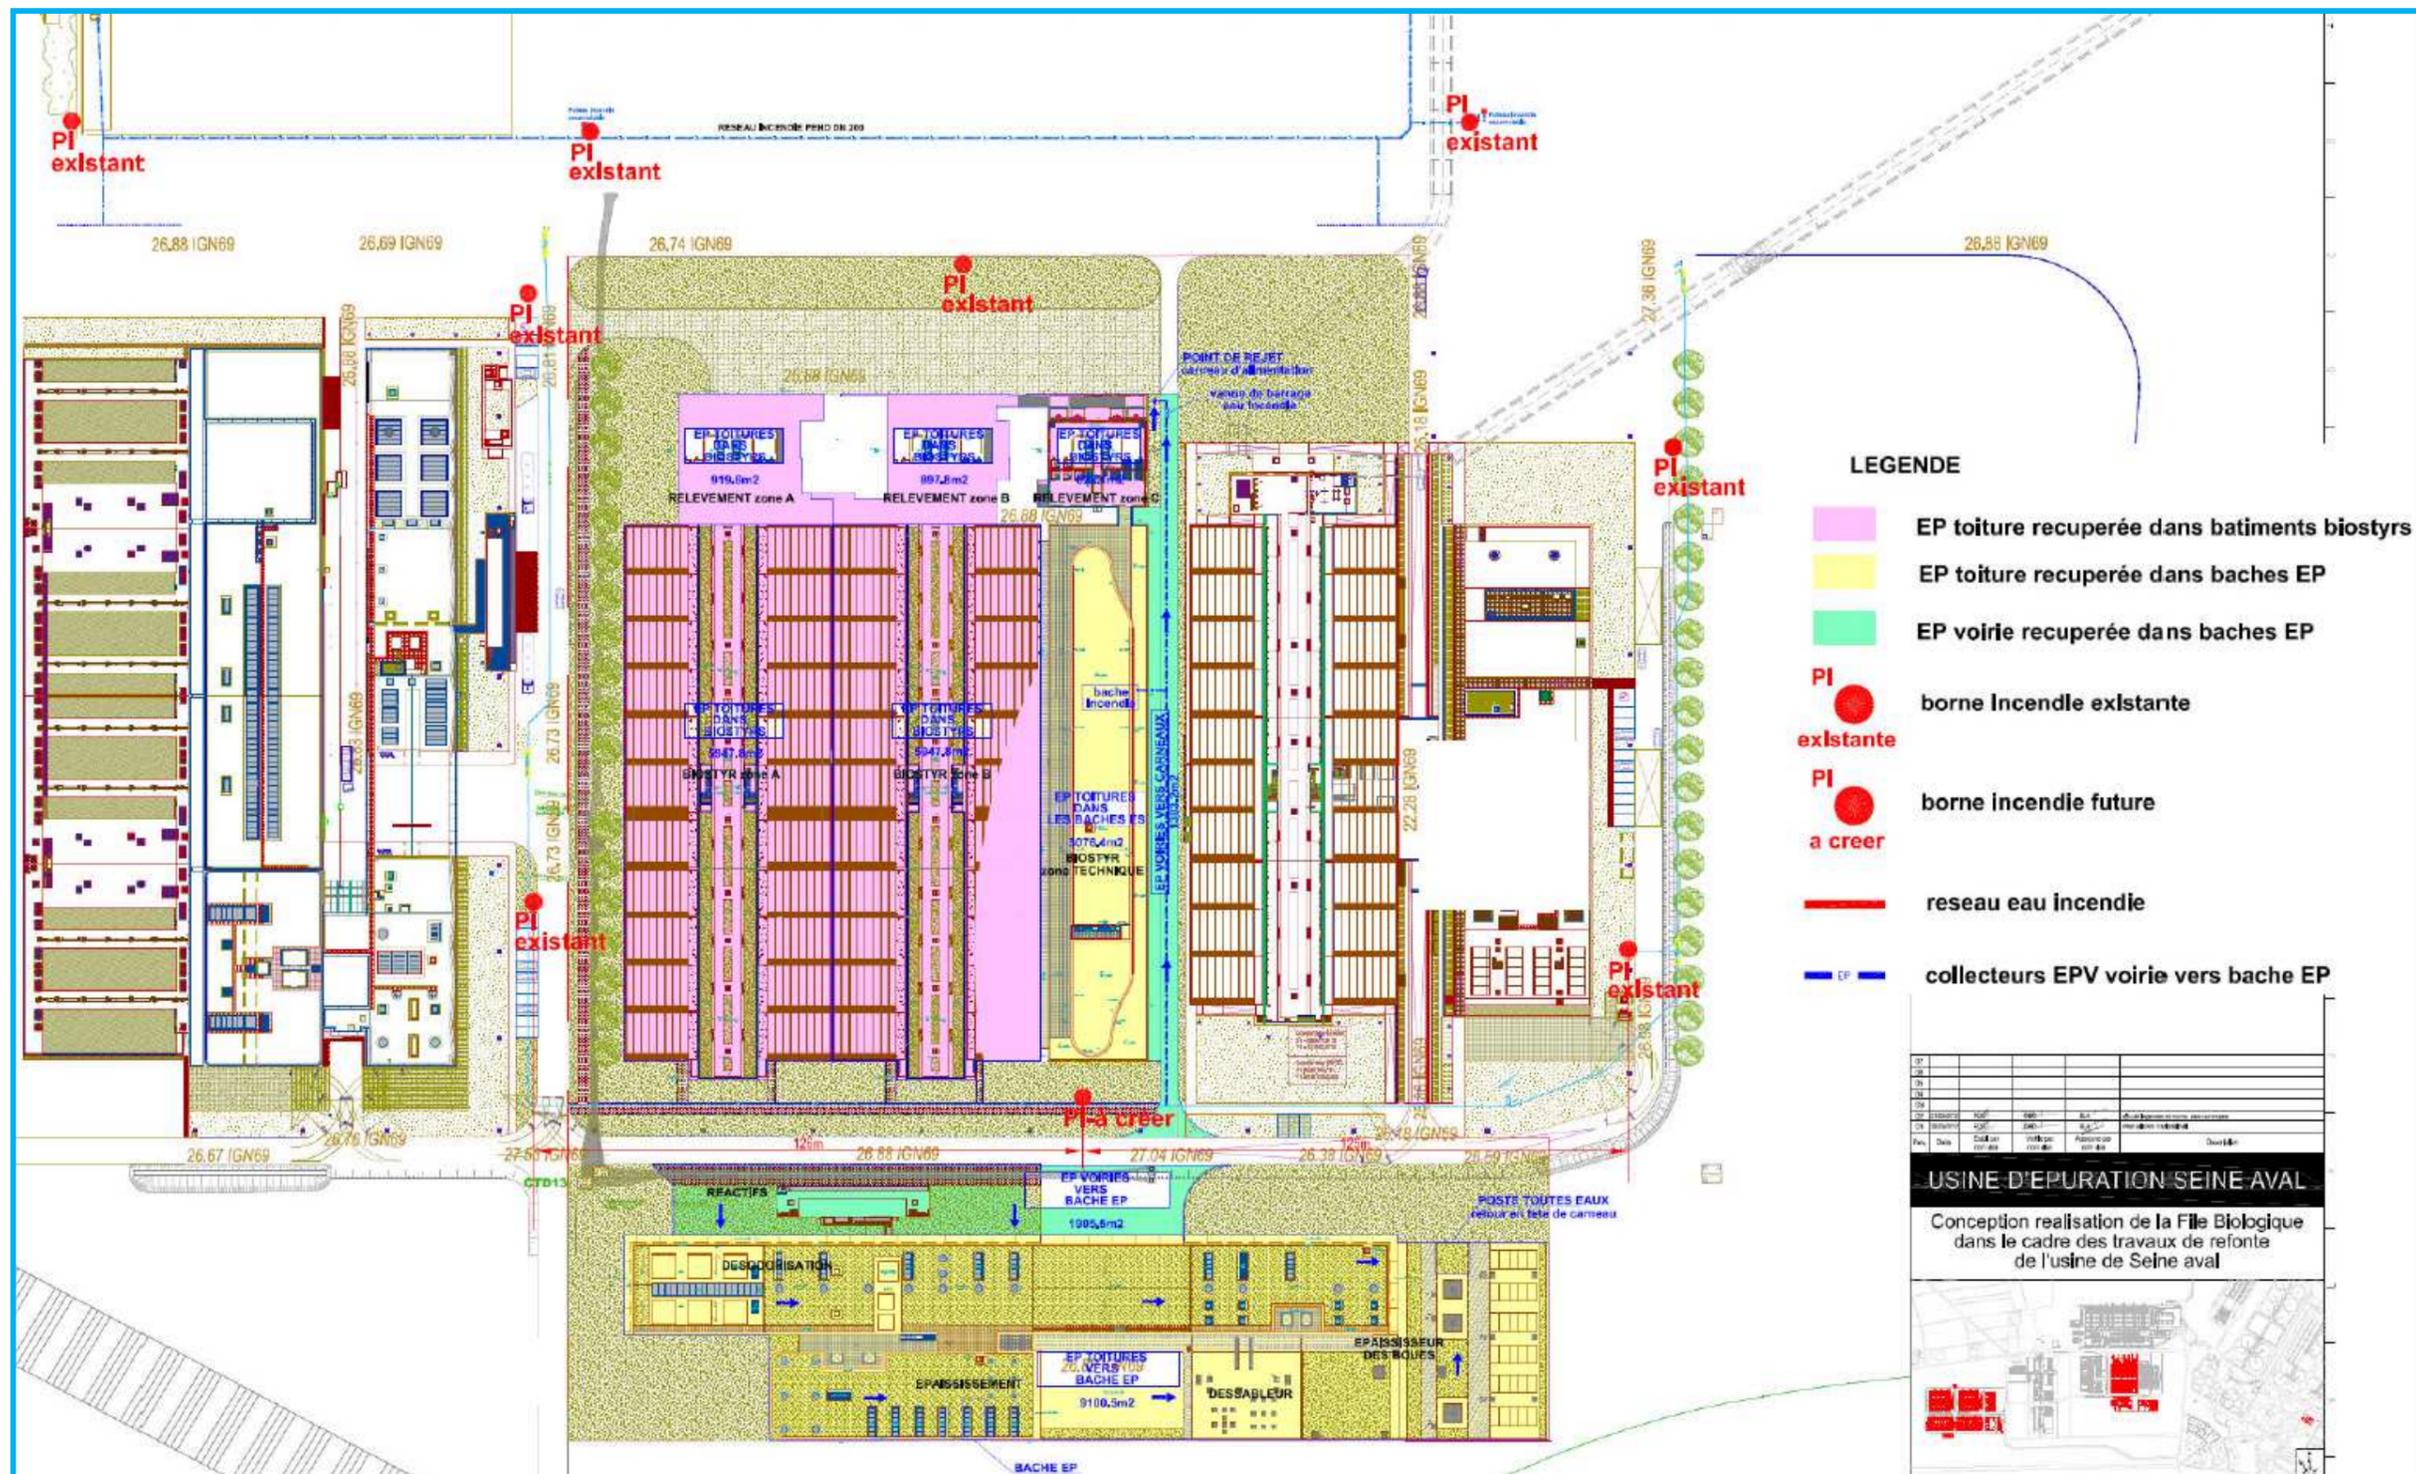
Plan de la gestion des eaux pluviales sur la zone du futur complément de biofiltration (source : document BIOGEP)
